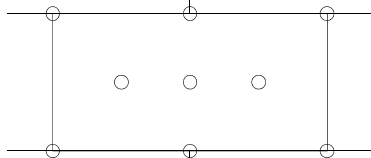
Panneaux de dimensions 1200 × 600 mm - plans de chevillage en plein - (espacement entre chevilles ≥ 150 mm)
